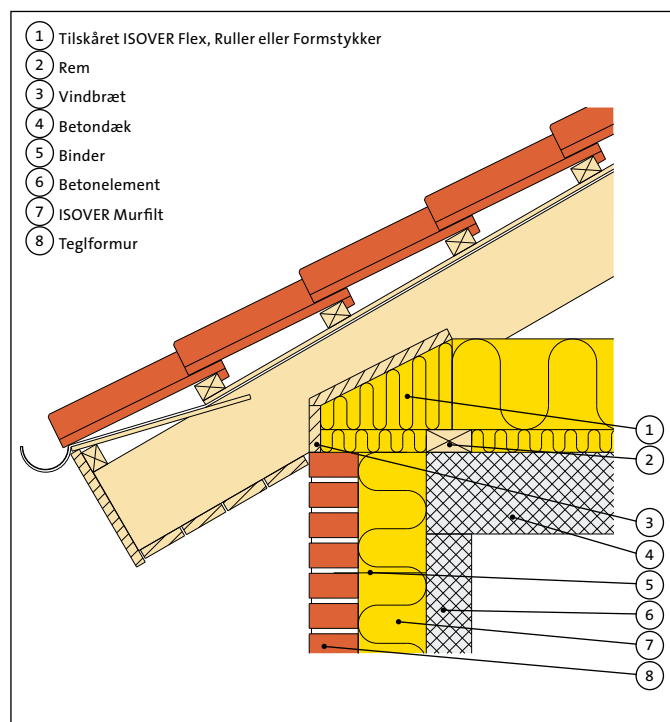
Ydervæg tegl/beton og betondæk.
